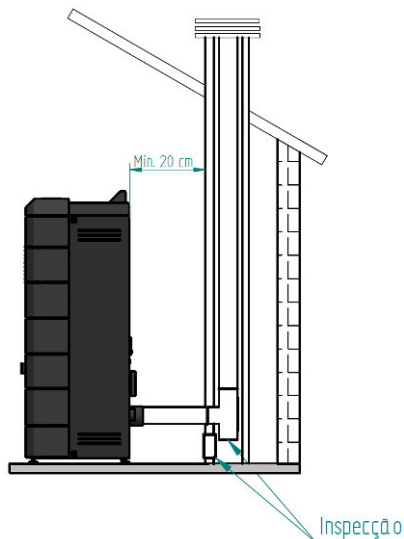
Vista lateral da instalação com chaminé, com exemplo do ponto de inspeção.
